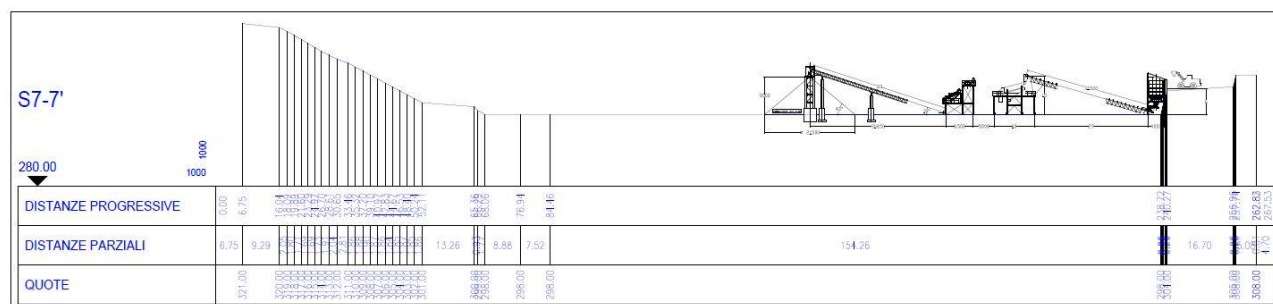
/C – Sezione di progetto S7-7' con impianto di lavaggio/separazione sabbie
